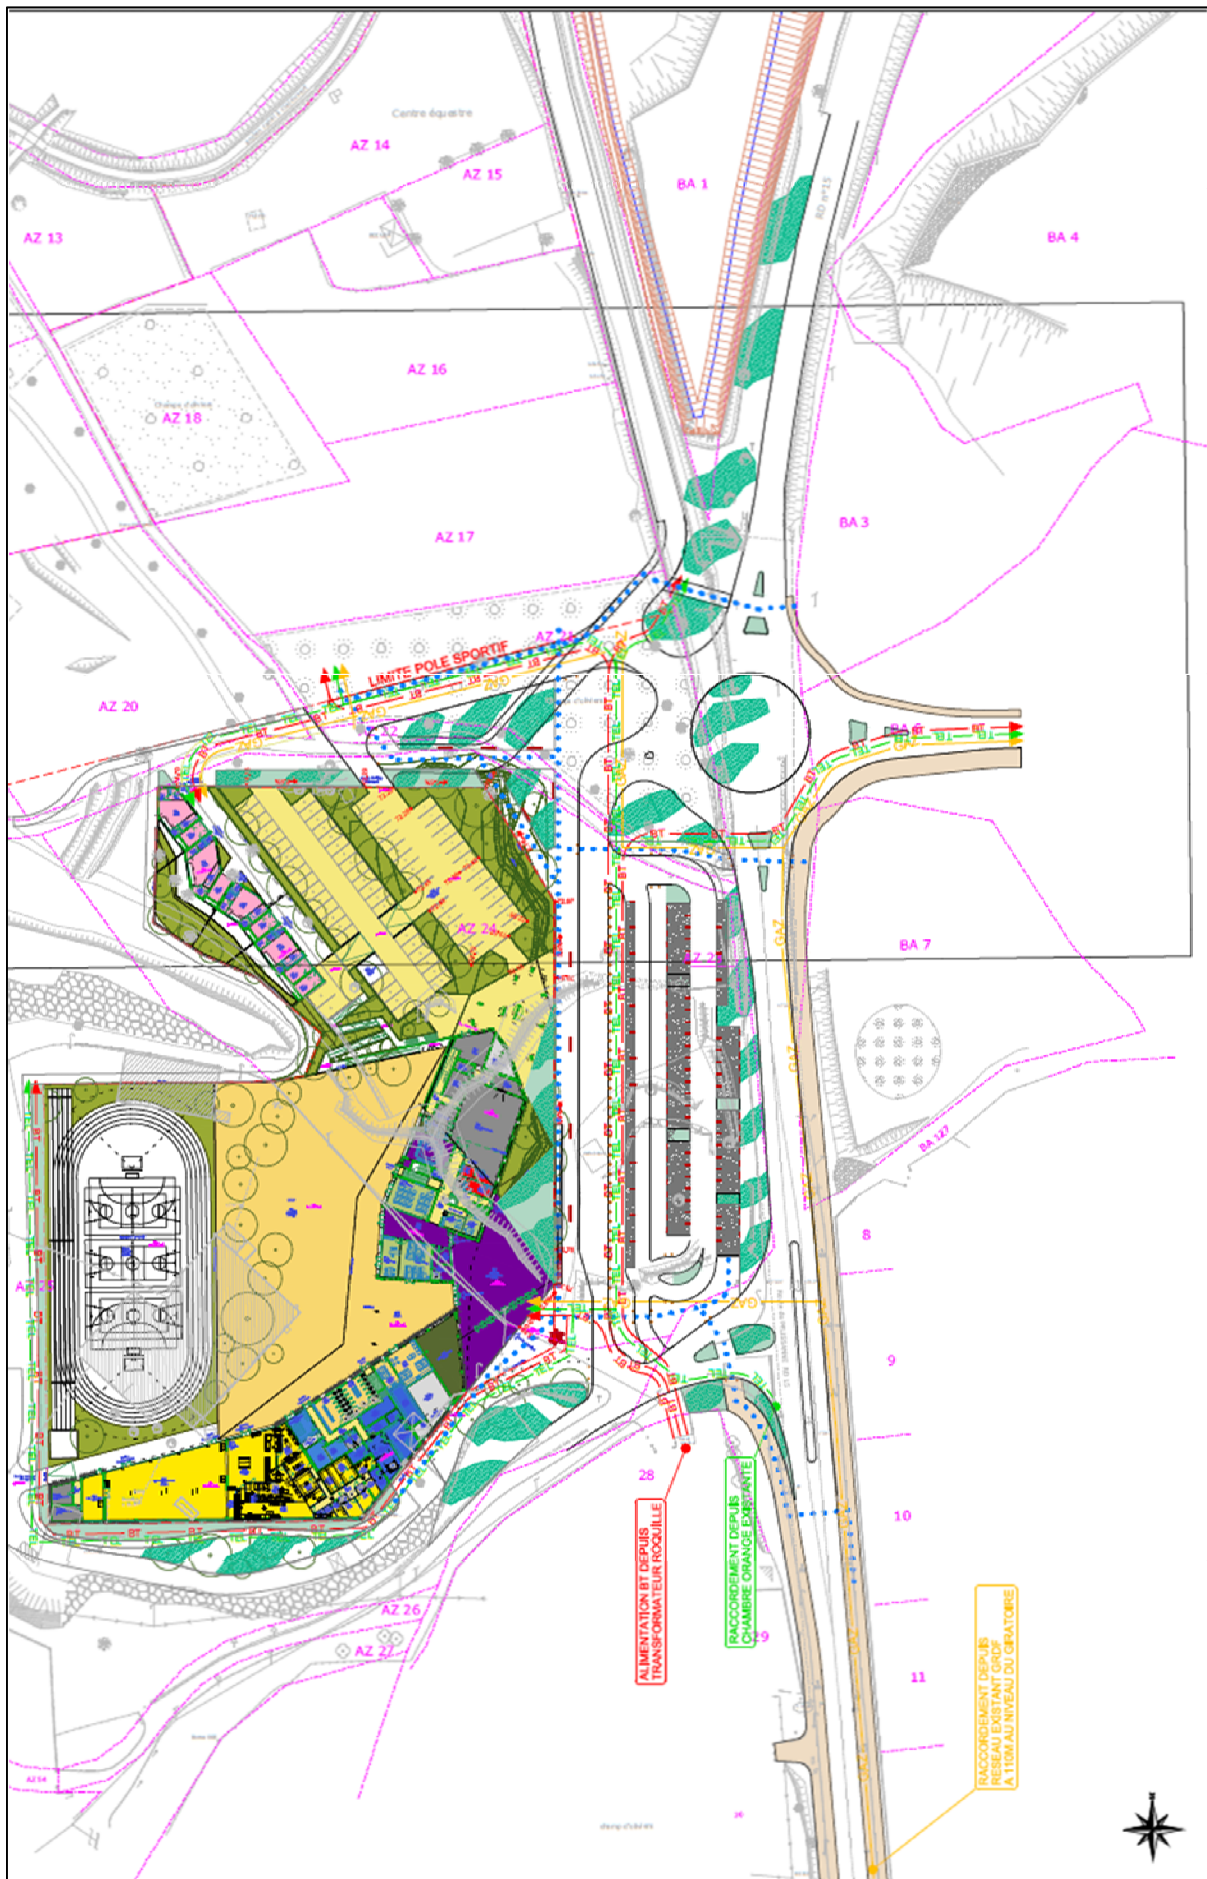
plan des réseaux secs au stade AVP (source SERI)
